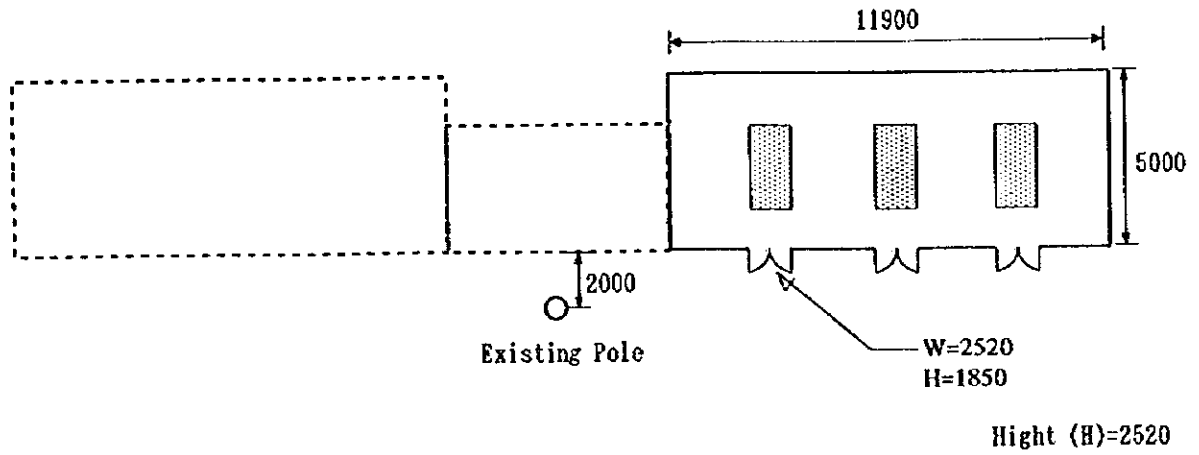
11 Munkhkhairkhan村の機器配置図
